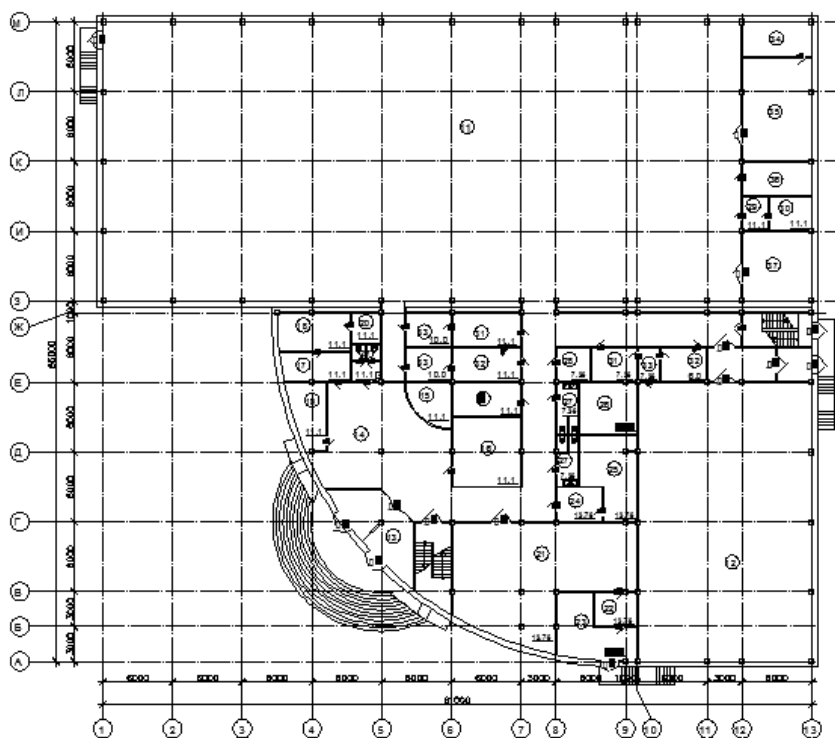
План 1 этажа здания бассейна на отметке 0.000
